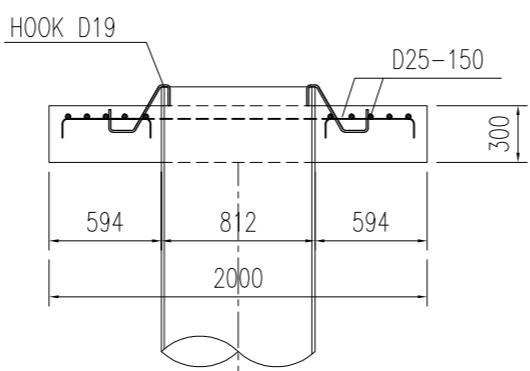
DETAIL PENULANGAN HEADSTOCK TIPE HS.2
